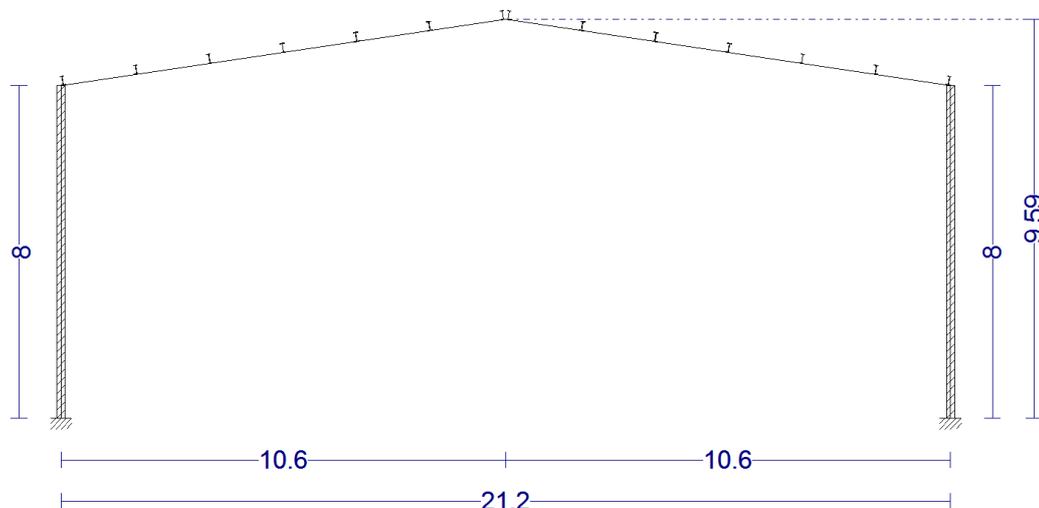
Imagen del pórtico rígido con correas de cubierta. Fuente: CYPE 2017
